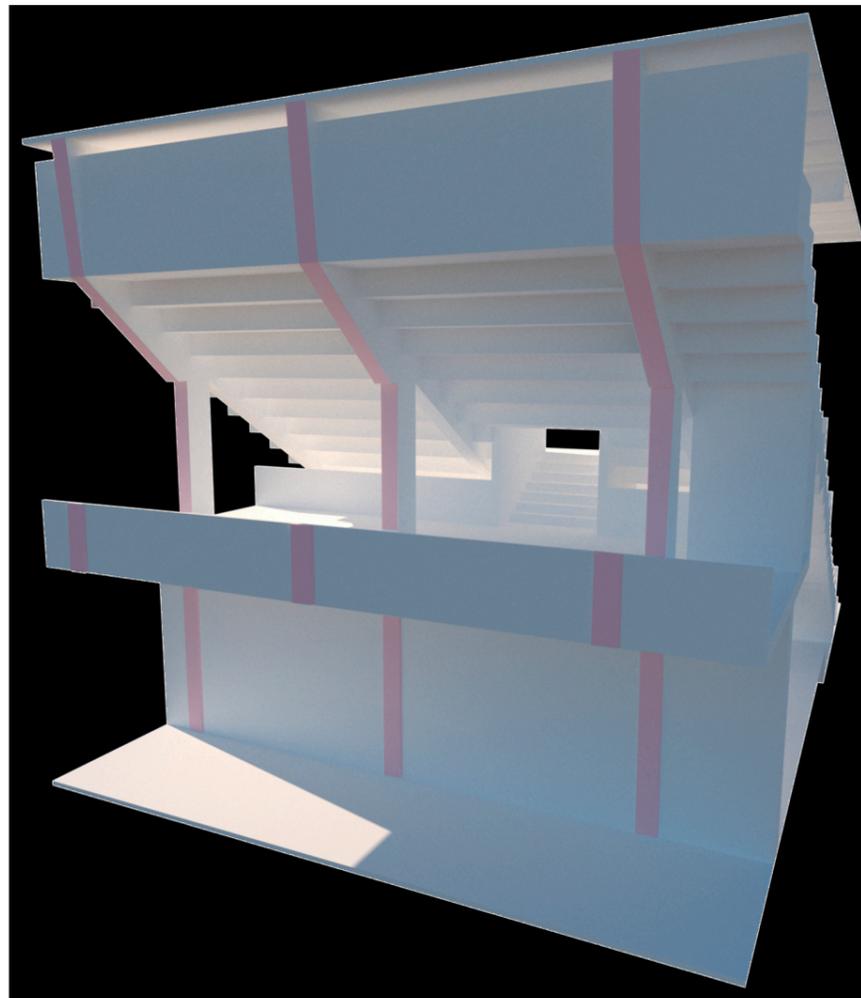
Detalle de la estructura en la fachada del actual estadio. Elaboración propia.
